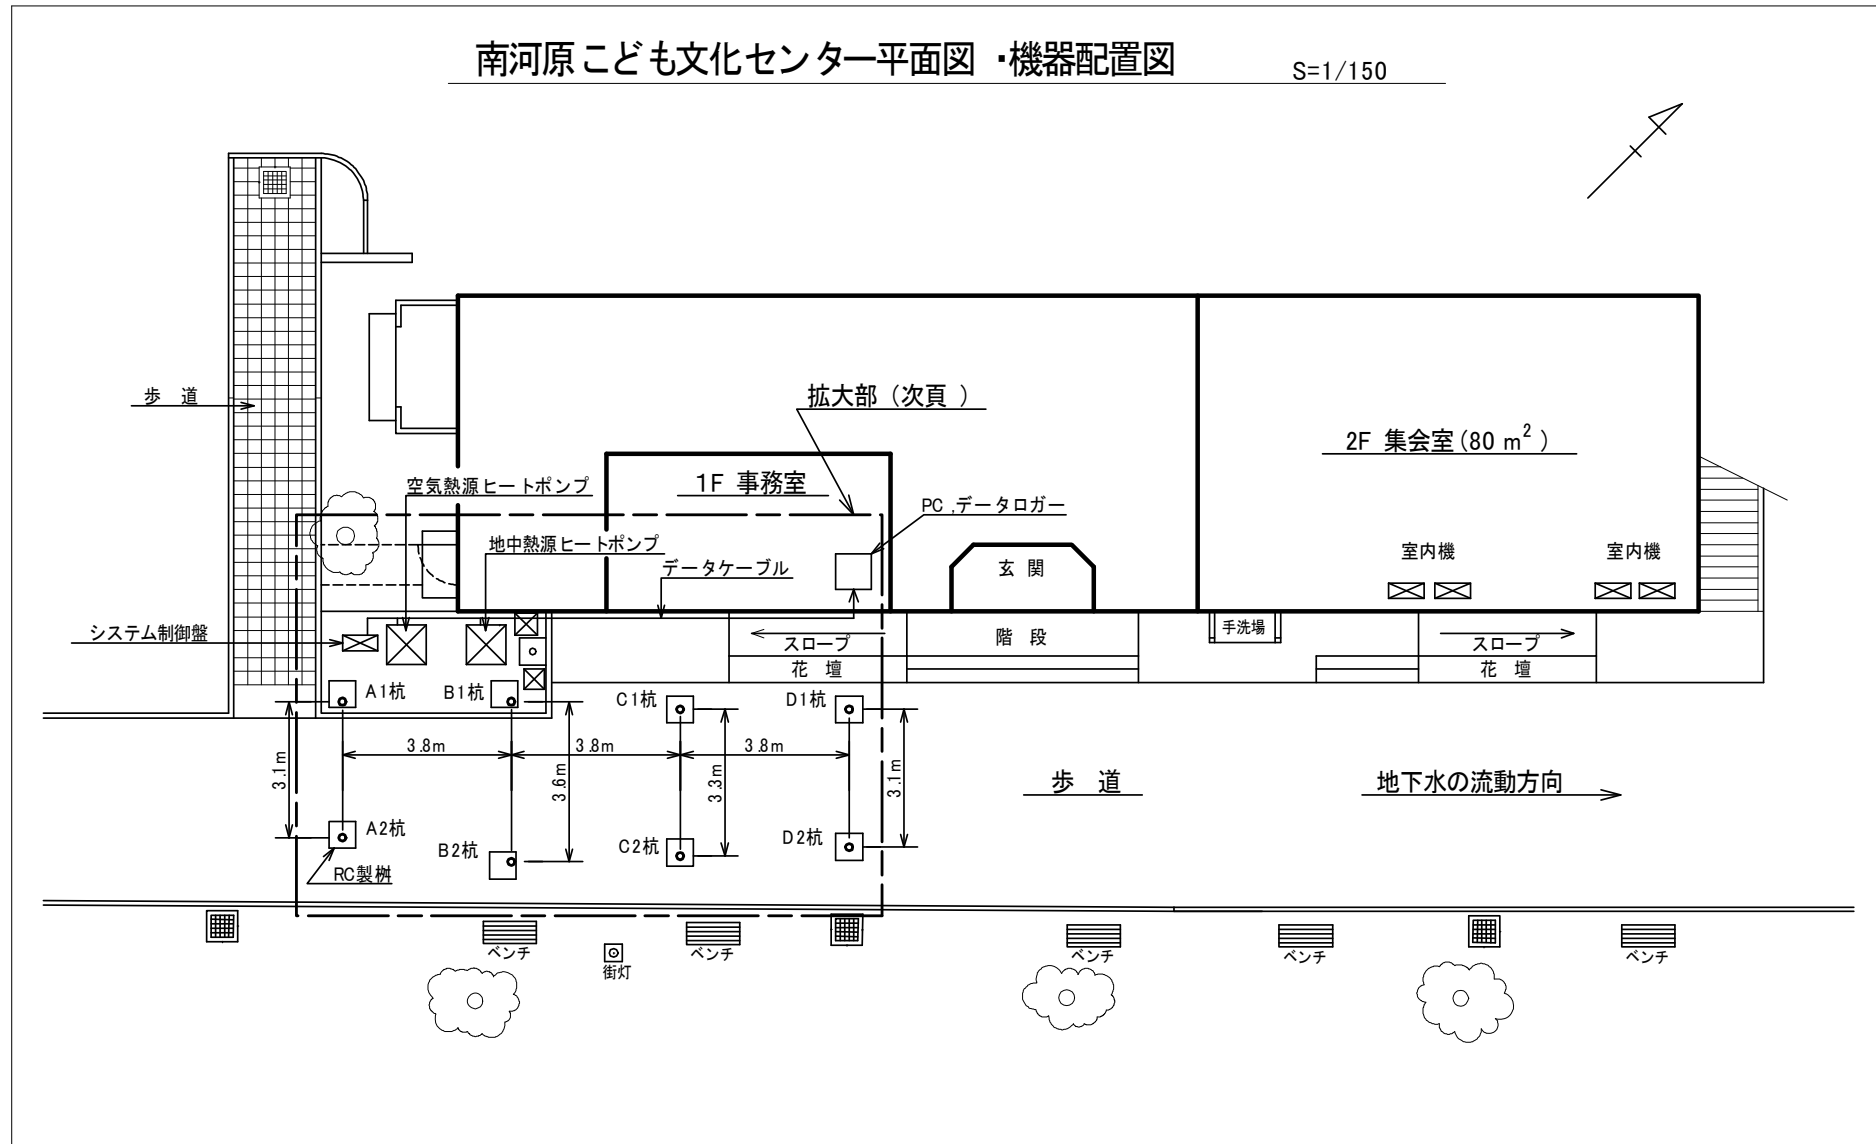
「川崎市 南河原こども文化センター」平面図及び機器配置図
